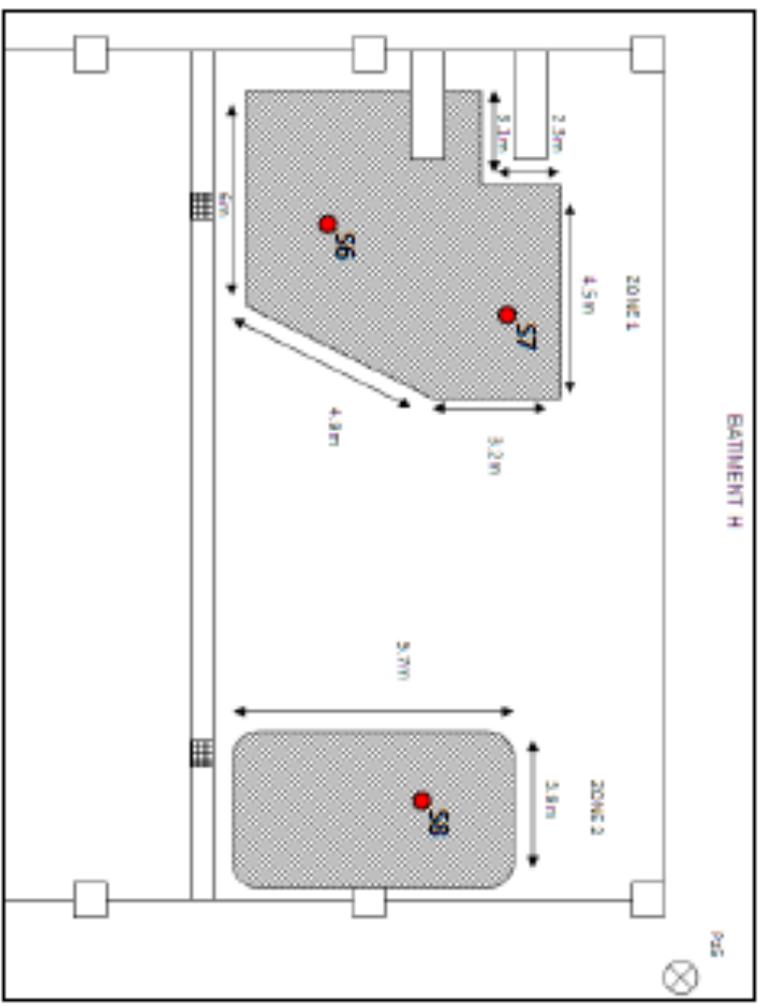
Plan de localisation des zones d'excavation en août (bâtiment H)
